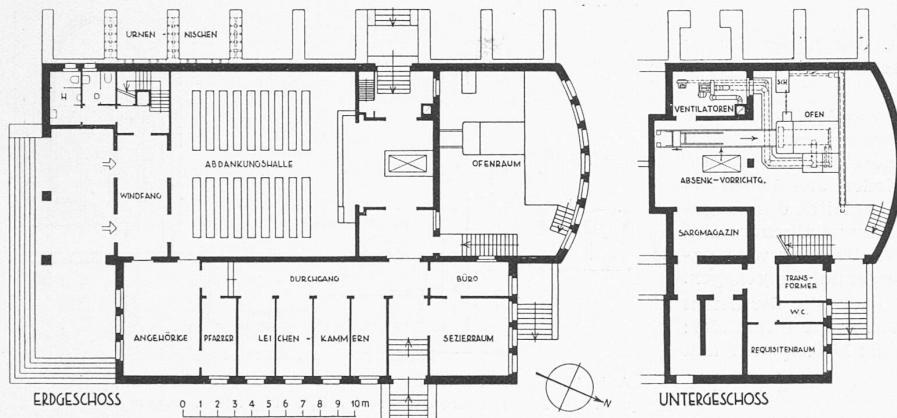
und 2. Grundrisse 1:400 des Krematoriums in Thun
